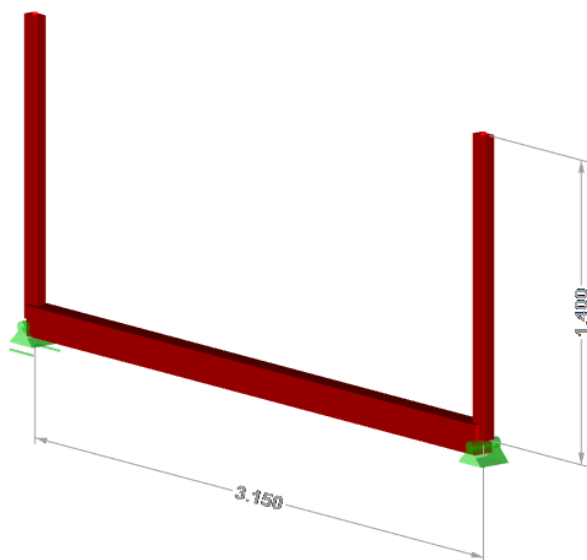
Geometrie pochozí konstrukce a zábradlí lávky
